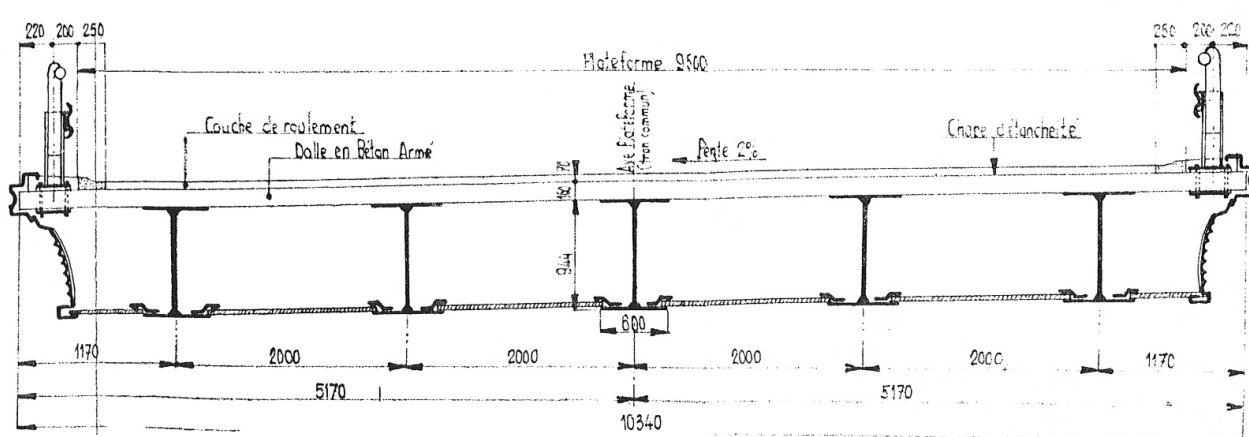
Extrait DOE – Coupe transversale de l'ouvrage
